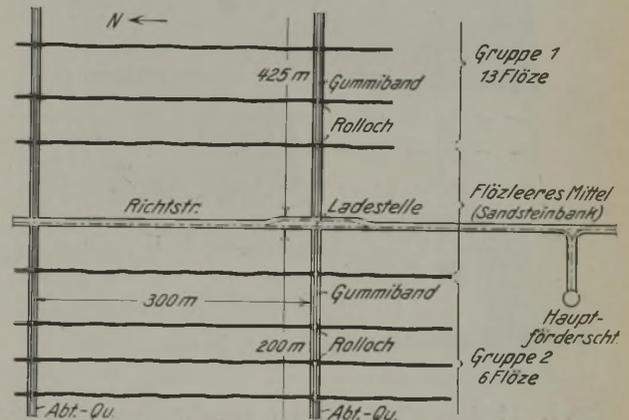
Grundriß der Hauptfördersole der Schachanlage Cuvelette.
